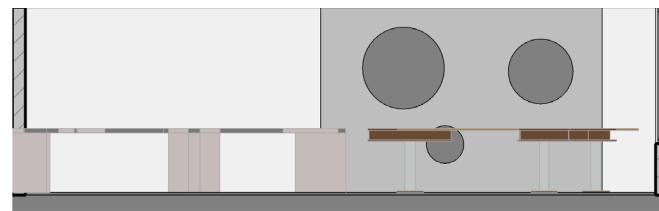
1era Plana Alta - Elevación 03 Pared con gypsum y estucado y pintado
